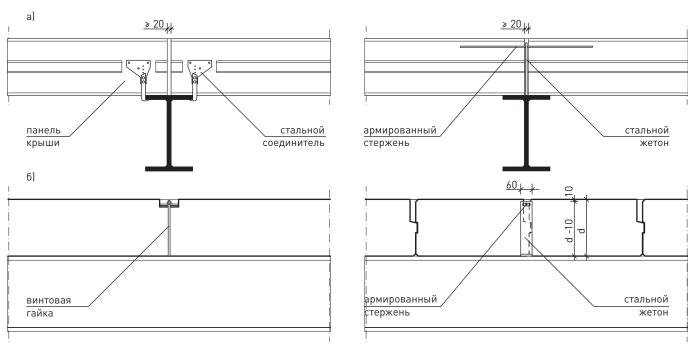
Крепления плит покрытия YTONG к металлической конструкции:
